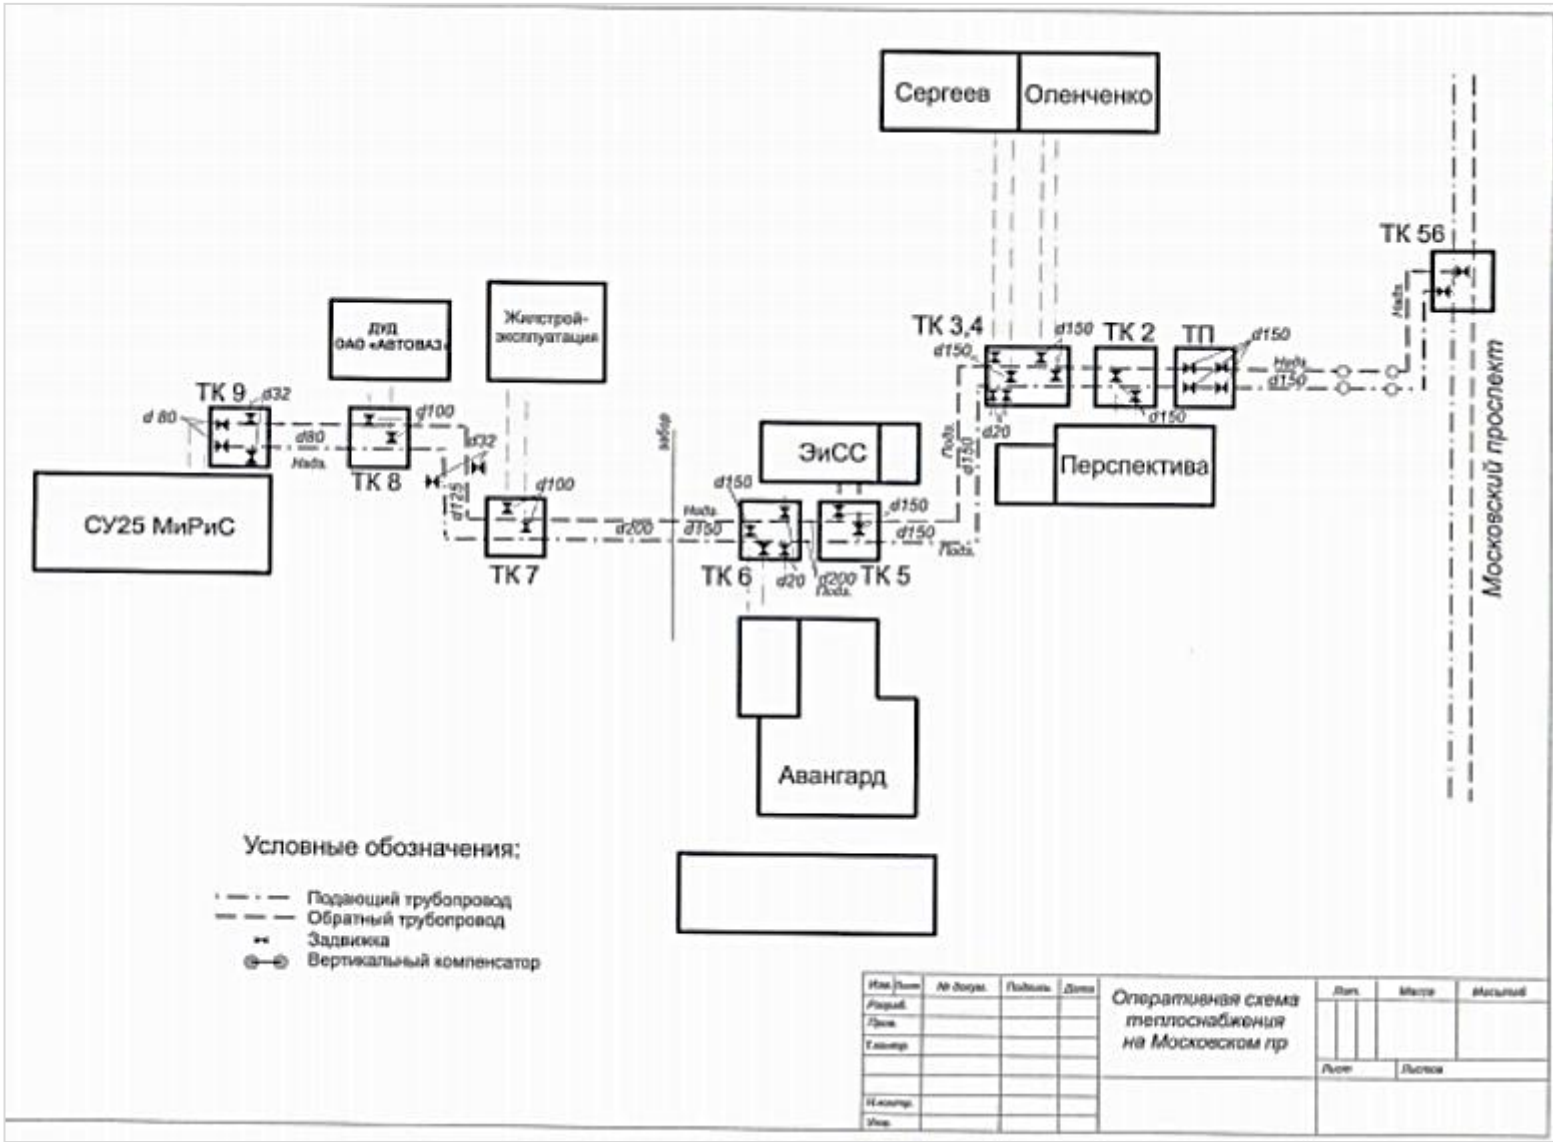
Схема трубопроводов тепловых сетей, от ТК-56
